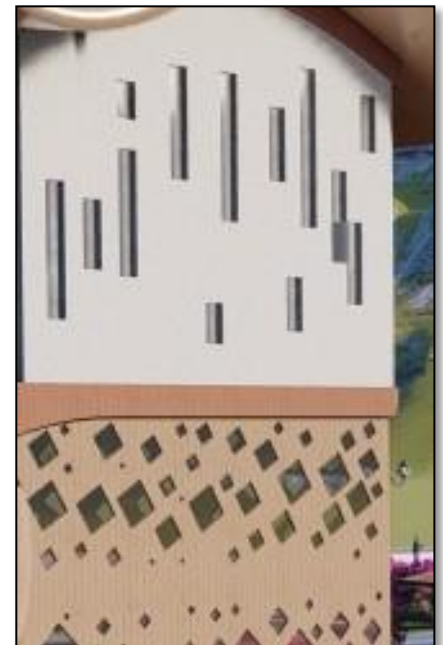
L'utilisation de la façade ventilée dans notre projet (Source: Auteur)
